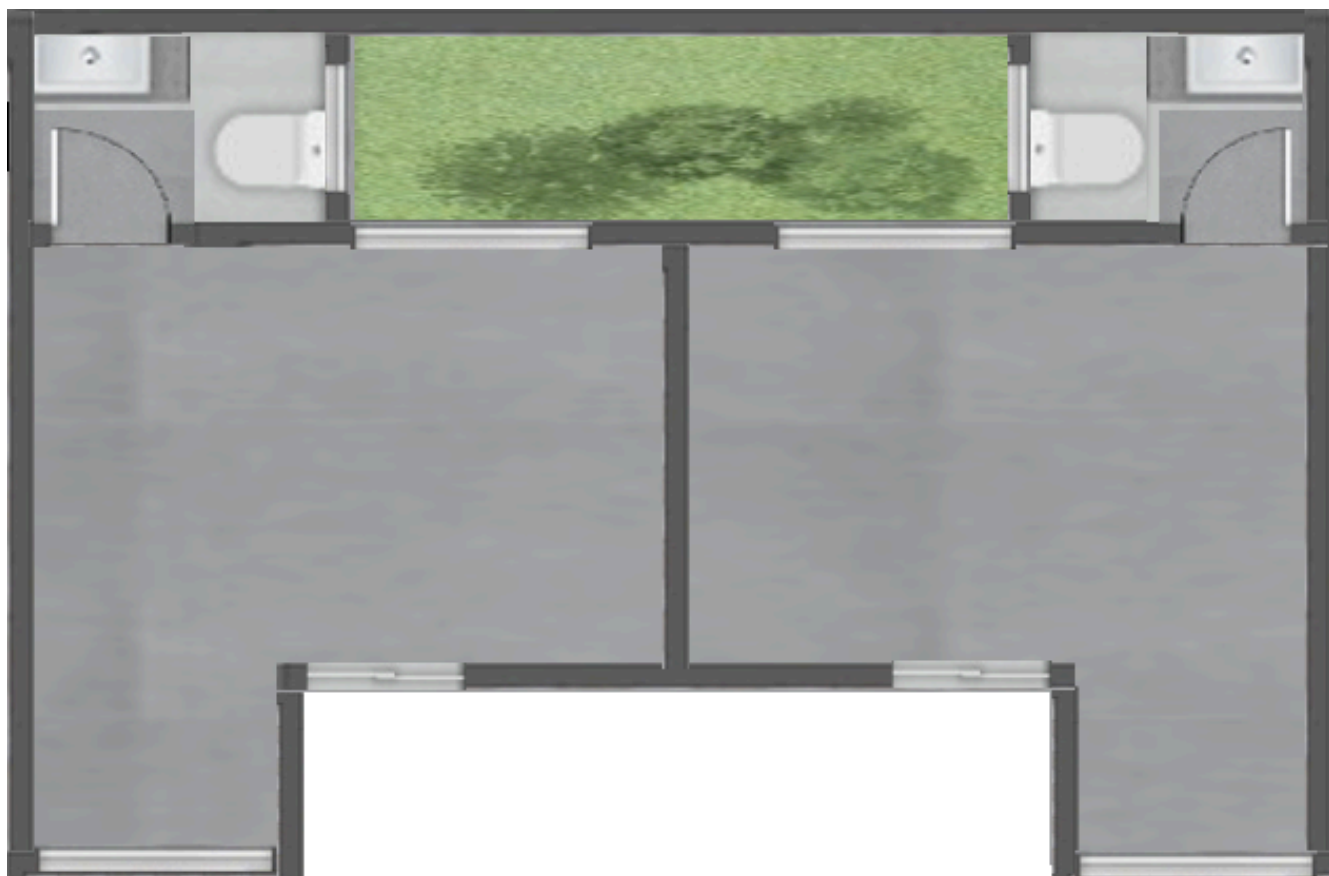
Planta baixa do projeto (realizada por software de desenho)
